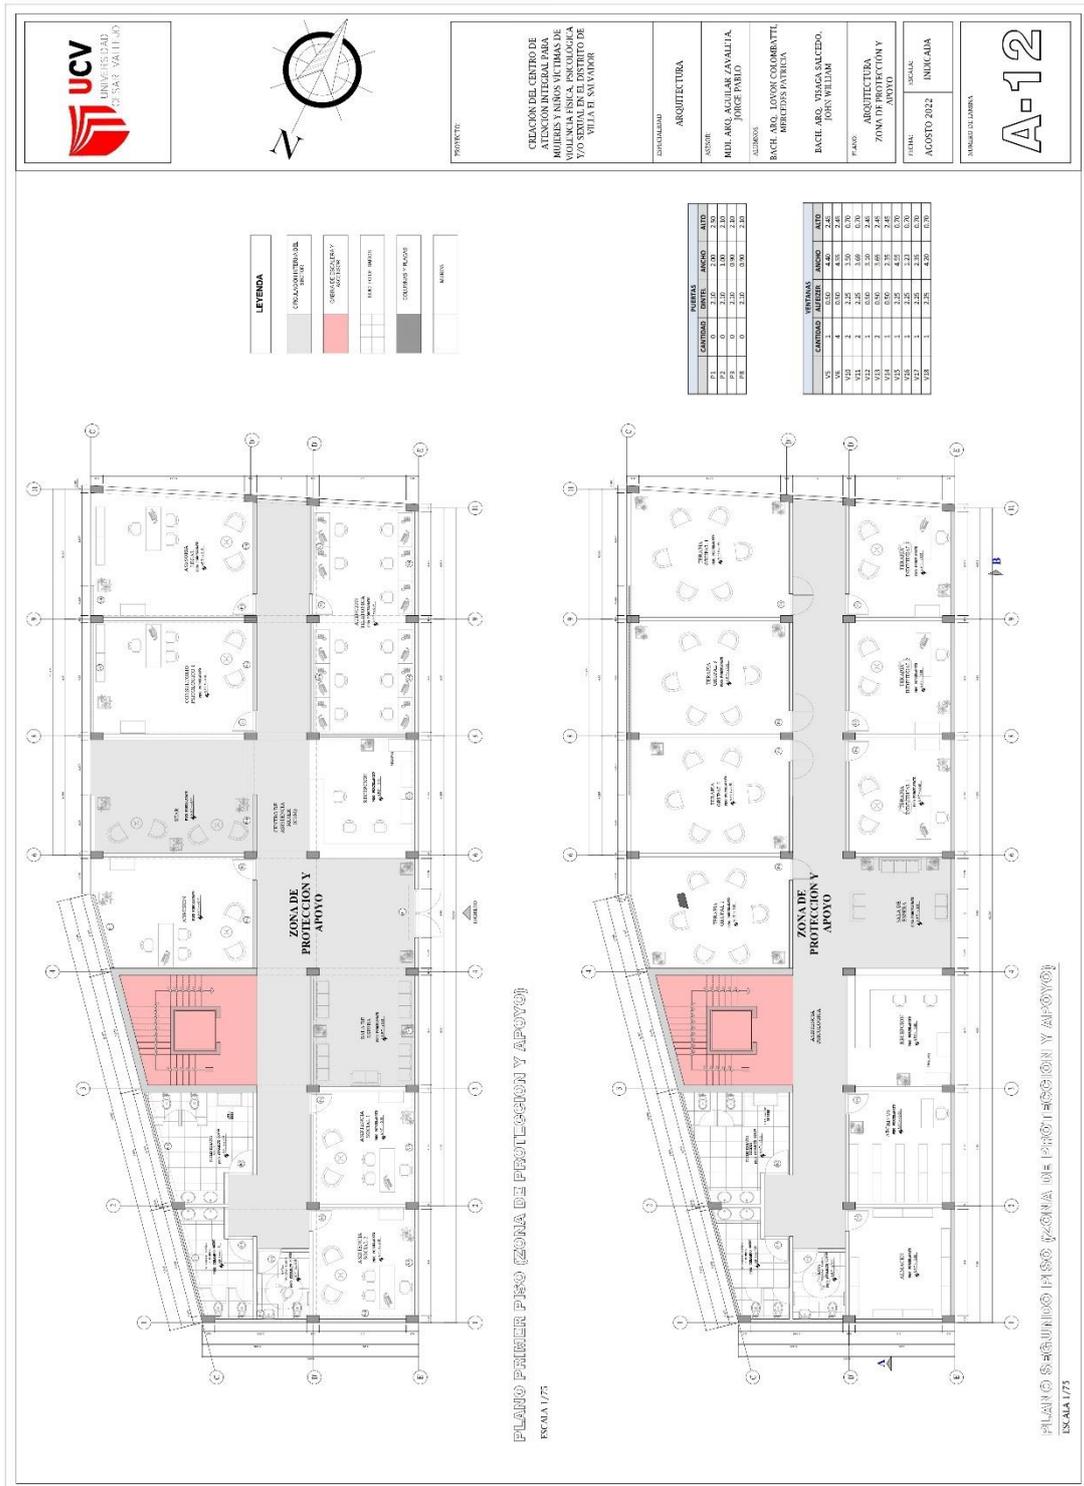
Plano Sector-Zona Protección y Apoyo
